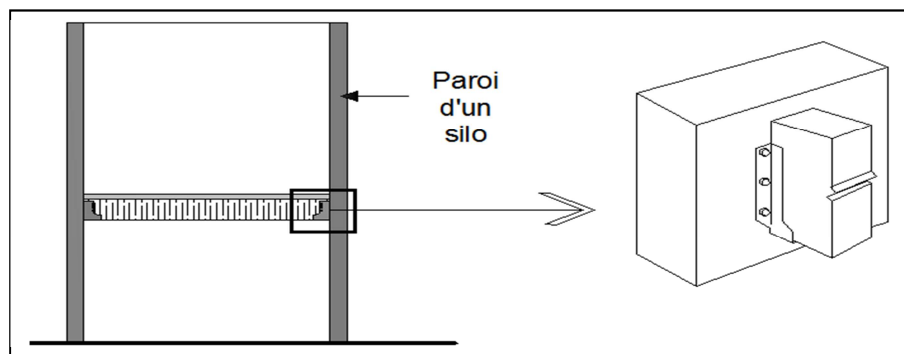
détail de construction, source: construire plancher en bois, tutoriel
